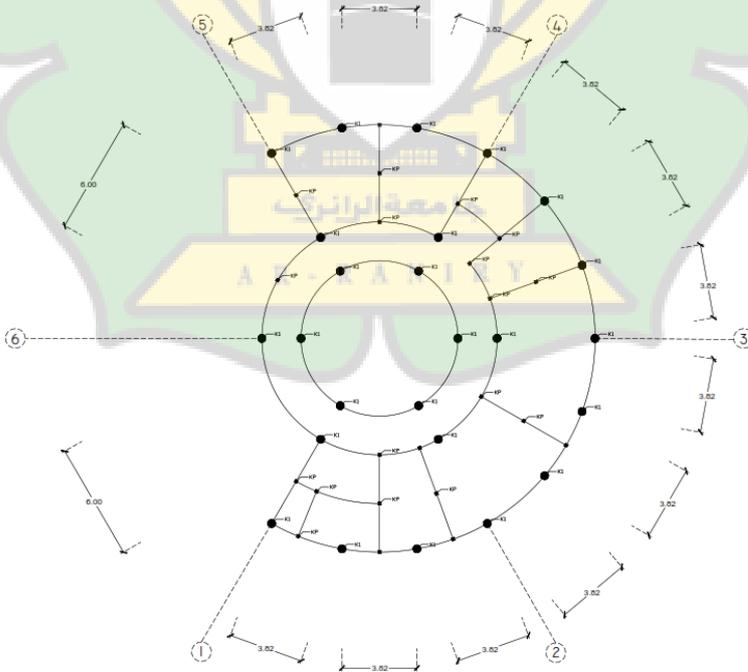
Denah Balok Elevasi +9.00 Lobby dan Pengelola
